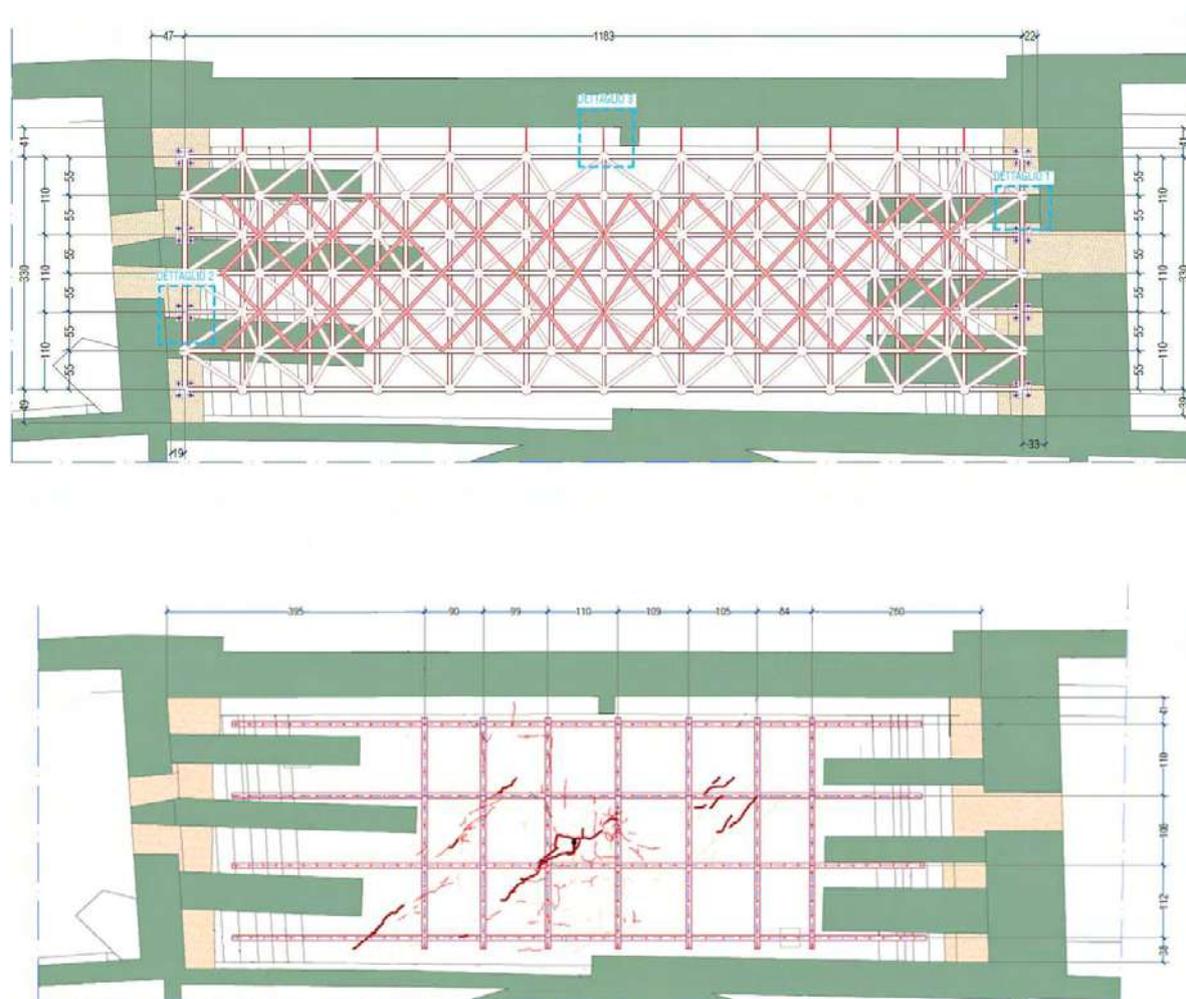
Piante della volta con il telaio reticolare di consolidamento e rafforzamento.
